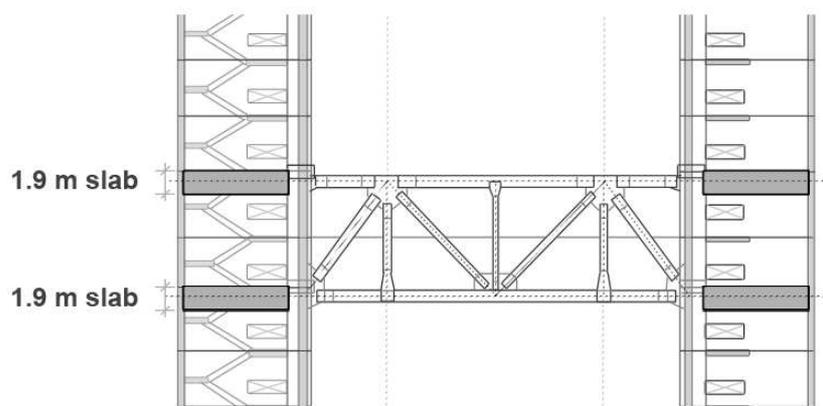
Situación de las losas de 1,9 m de espesor en los núcleos de la Torre Bankia.
